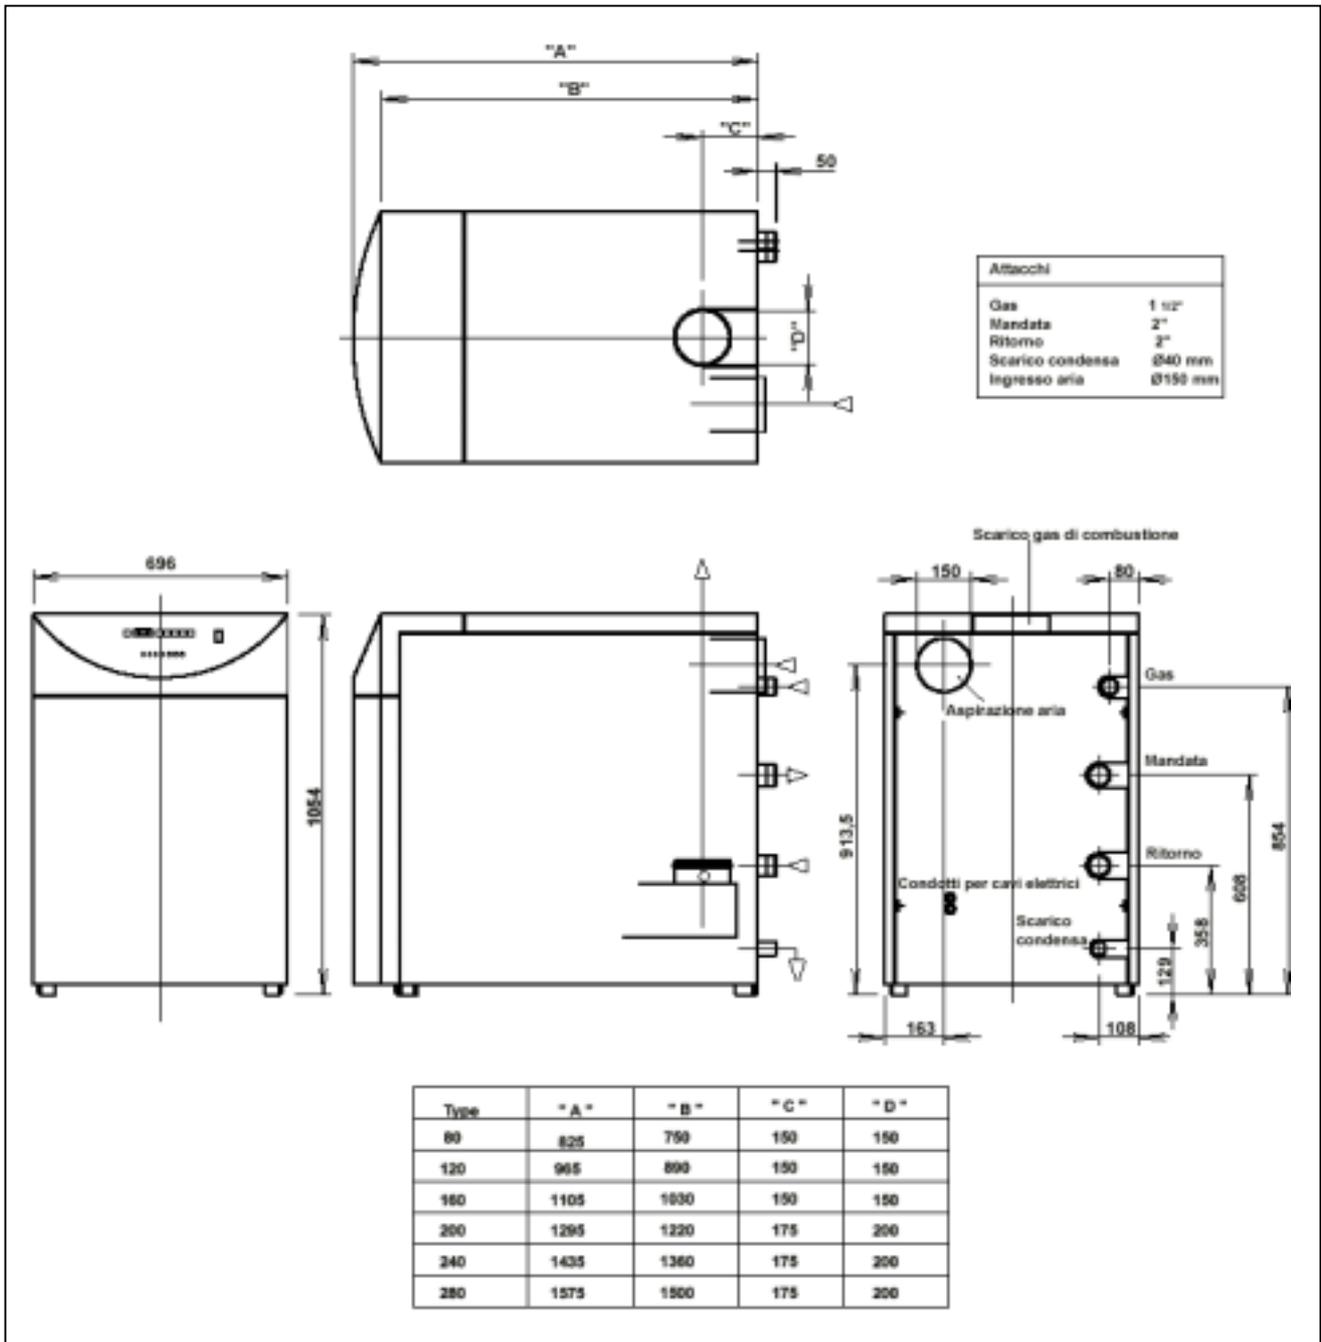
Dimensioni d'ingombro. Tutte le dimensioni sono espresse in mm
